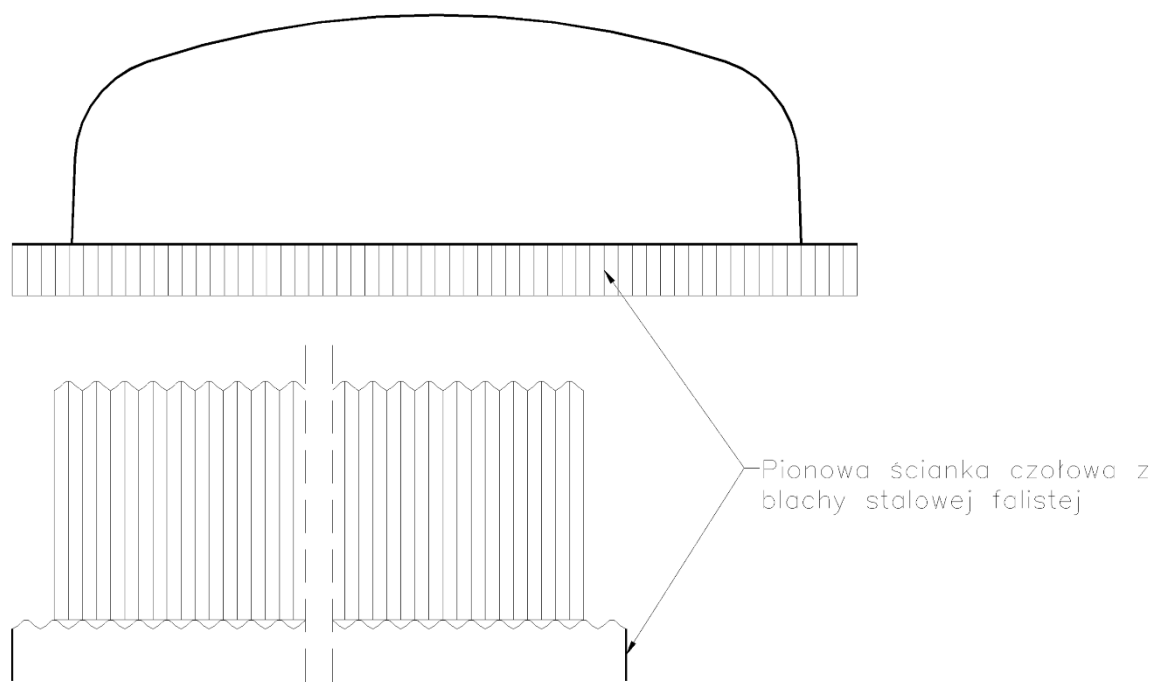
Konstrukcja na stalowych blachach falistych.
